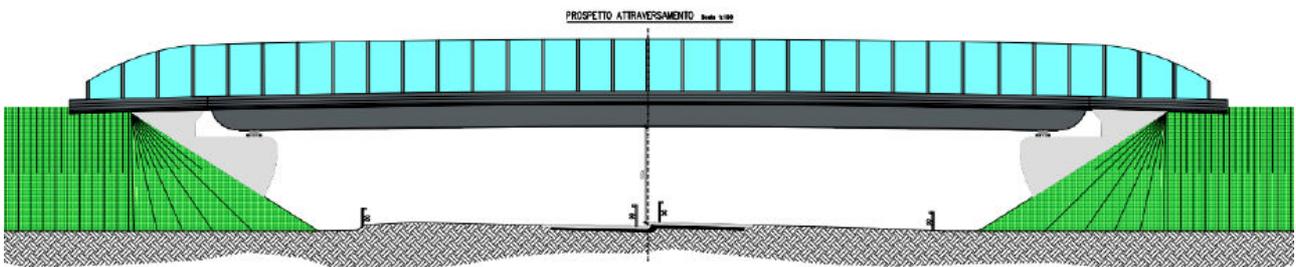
Prospetto attraversamento del sovrappasso in progetto (Fonte: Allegati alla Lista di controllo)
